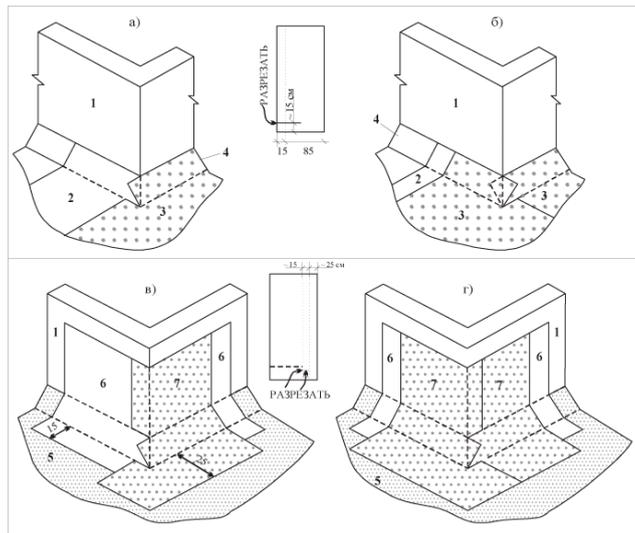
Розкладка та розкрій Акваізолу при влаштуванні покрівельного килима (а, б - основного шару, в, г - додаткового) на поверхні зовнішнього кута
